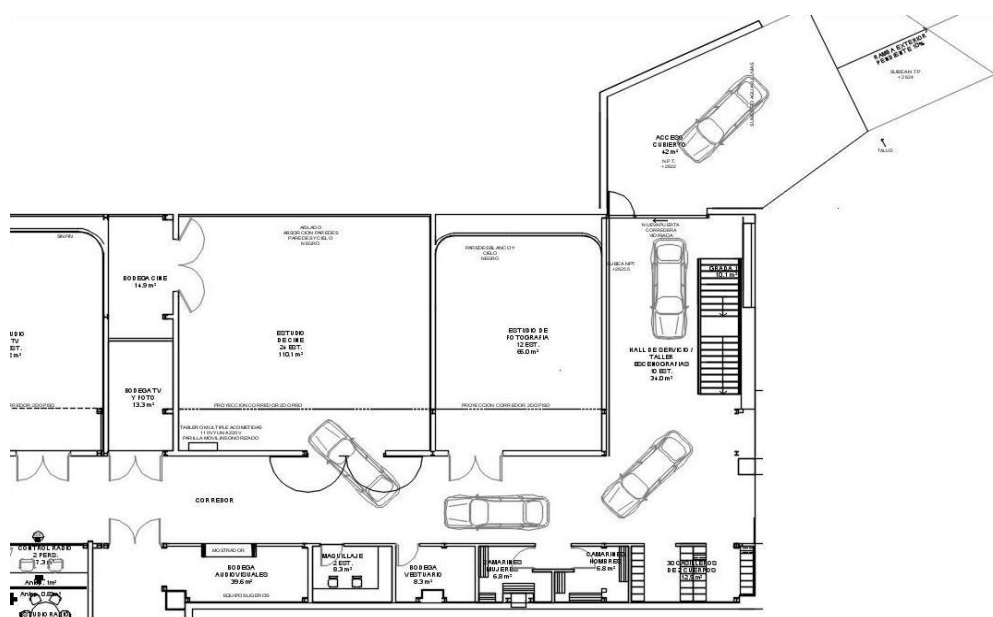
Plano arquitectónico rampa de acceso vehicular.
